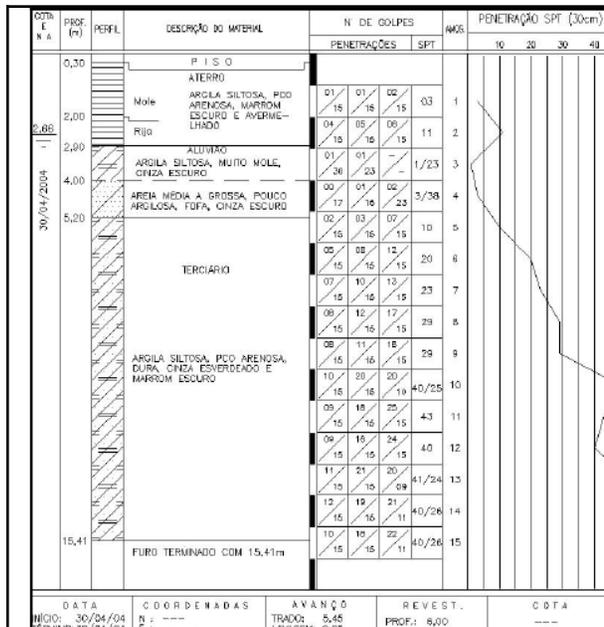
Perfil Geotécnico – SP - 01 – Córrego Água Preta
